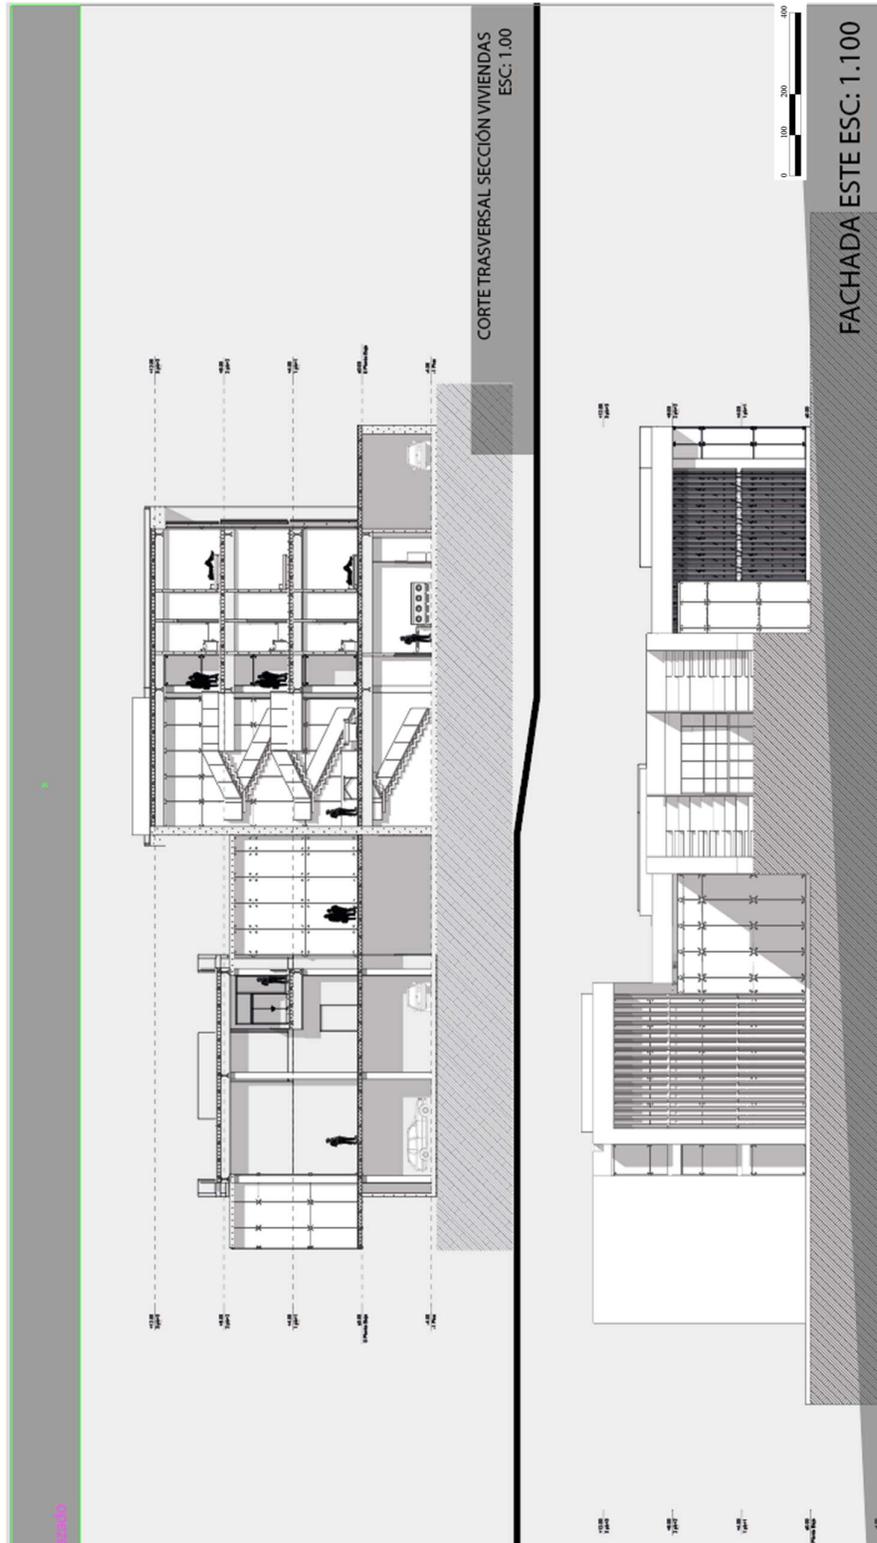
Fachada proyecto más sección longitudinal Elaboración propia
